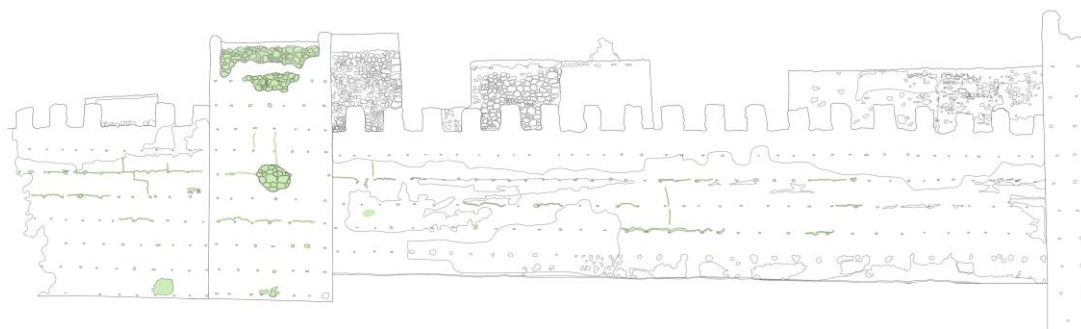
Alzado Norte con fisuras y oquedades en torre C y lienzo 3. Escala 1 /200. Fuente: Autora.
